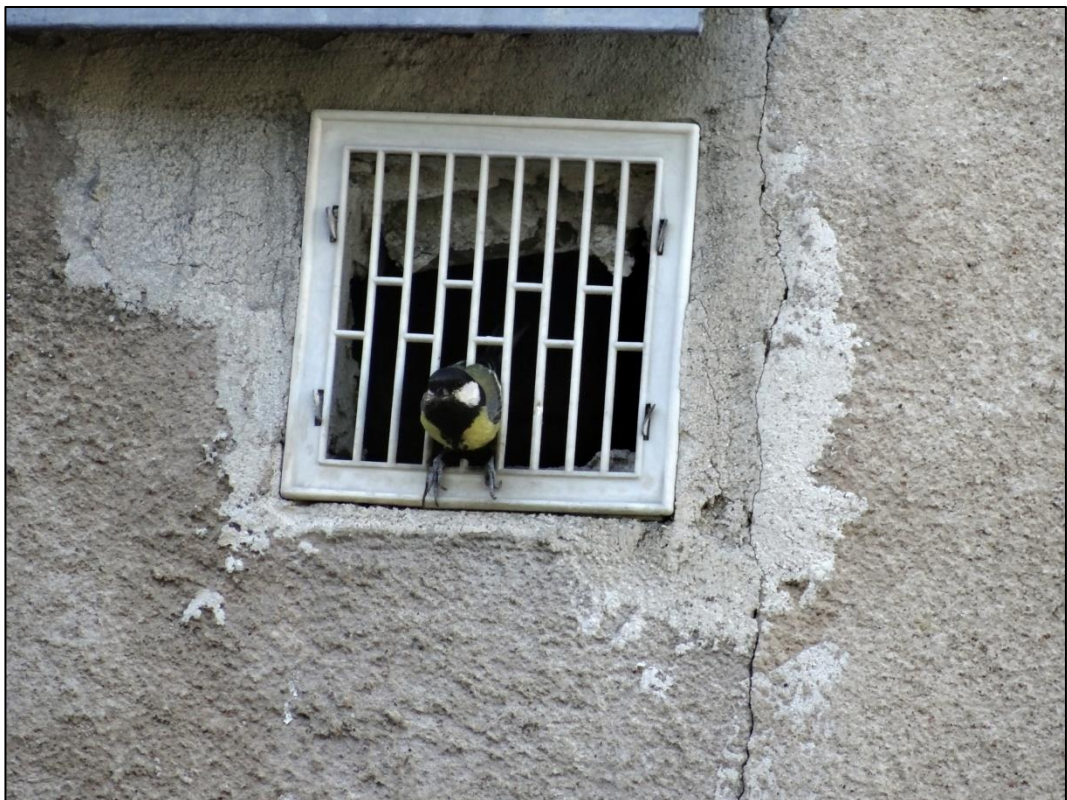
Szkoła Podstawowa w Garbnie – elewacja główna (strona lewa) cz. C.
